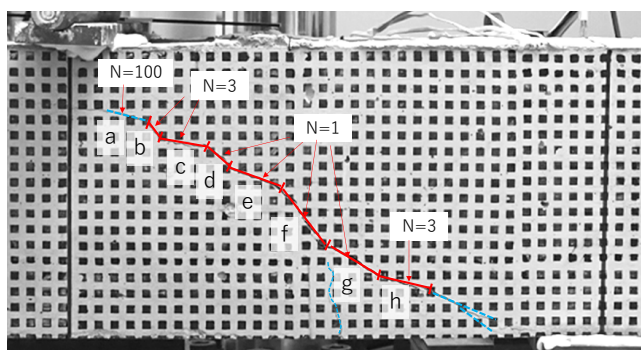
ひび割れ幅とずれ量の測定手法
